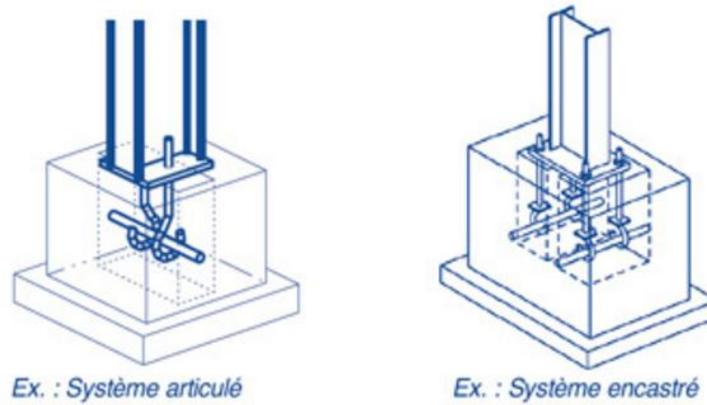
¹²⁹: l'assemblage du poteau métallique avec la fondation
